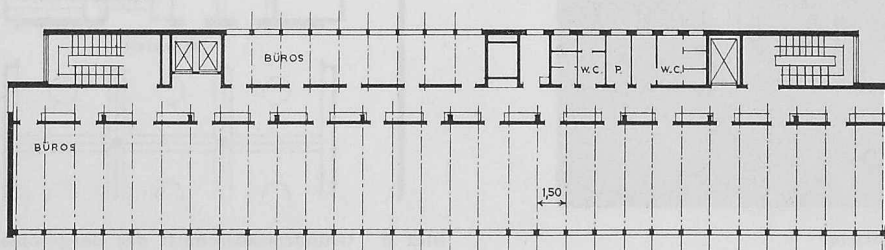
Grundriss des Bürogebäudes, 1:400
